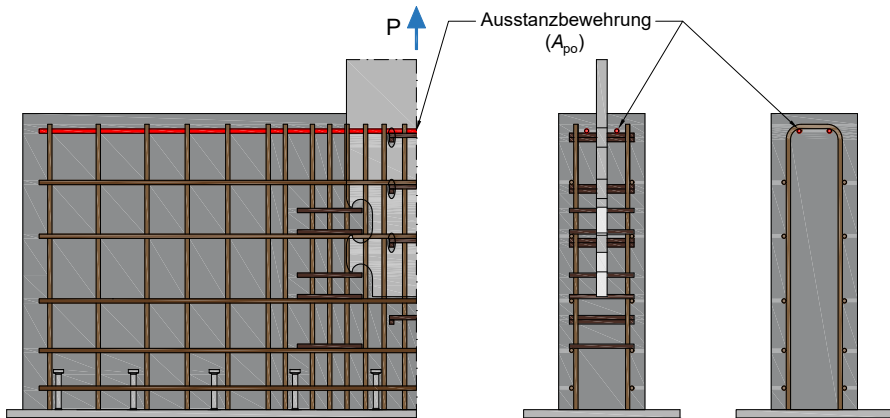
Darstellung des Einbaus der erforderlichen Ausstanzbewehrung ( $A_{po}$ )
